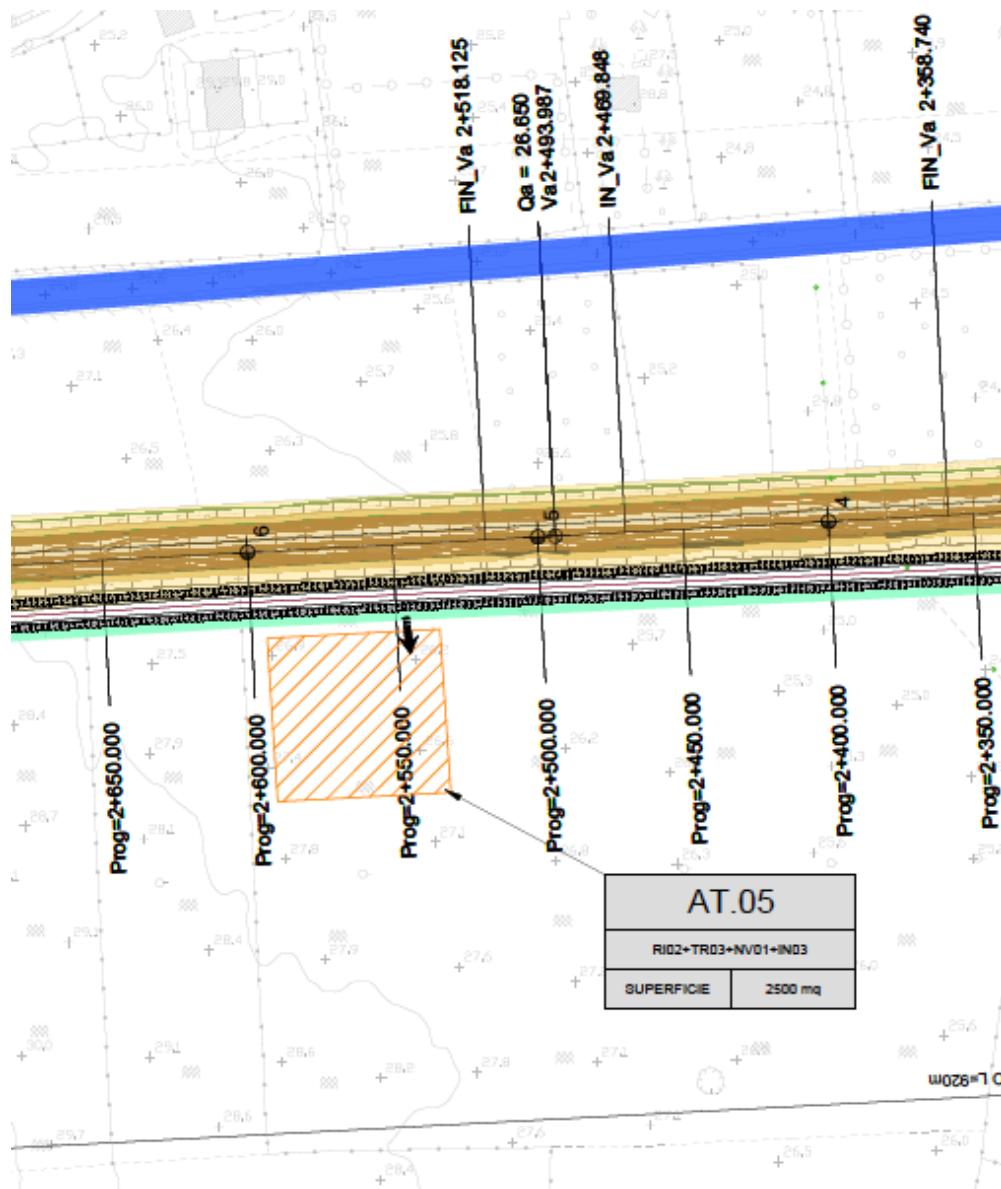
Vista in pianta dell'area di cantiere AT.05
